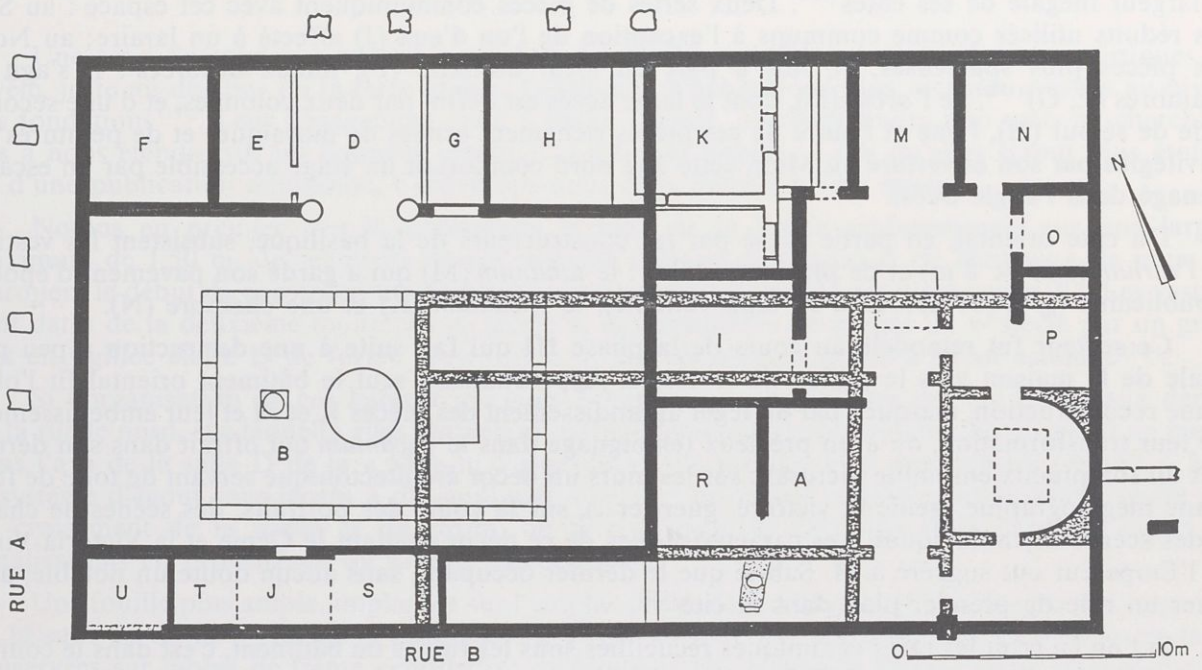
La Maison à Portiques (états 1-2-3) et la basilique : plan général des fouilles.
